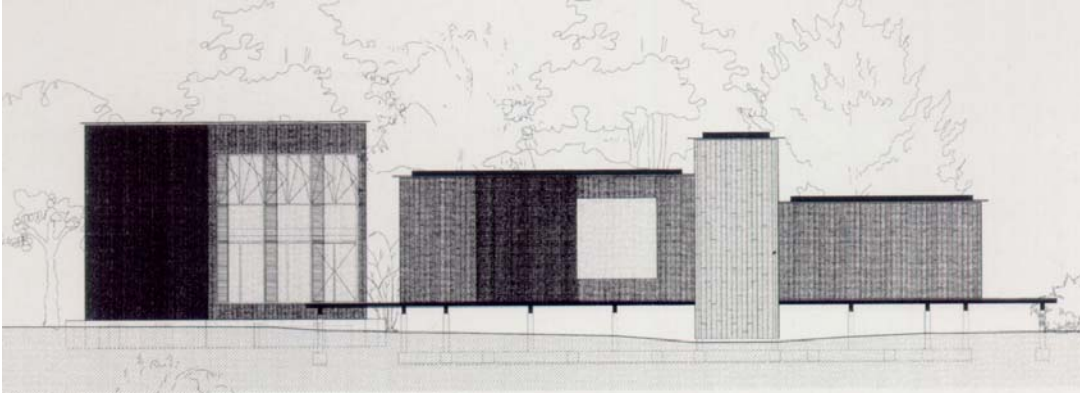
House and Office* - elevação. Fonte: Stungo (1998)
